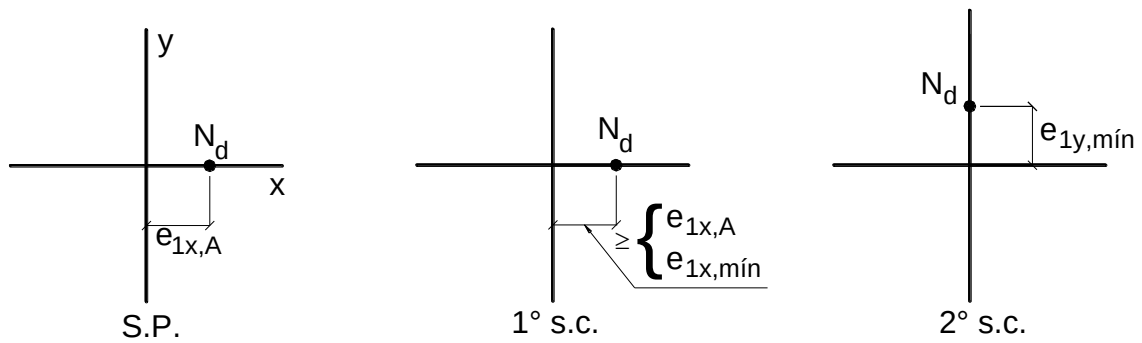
Situação de projeto e de cálculo para as seções de extremidade (topo e base) dos pilares de extremidade.
